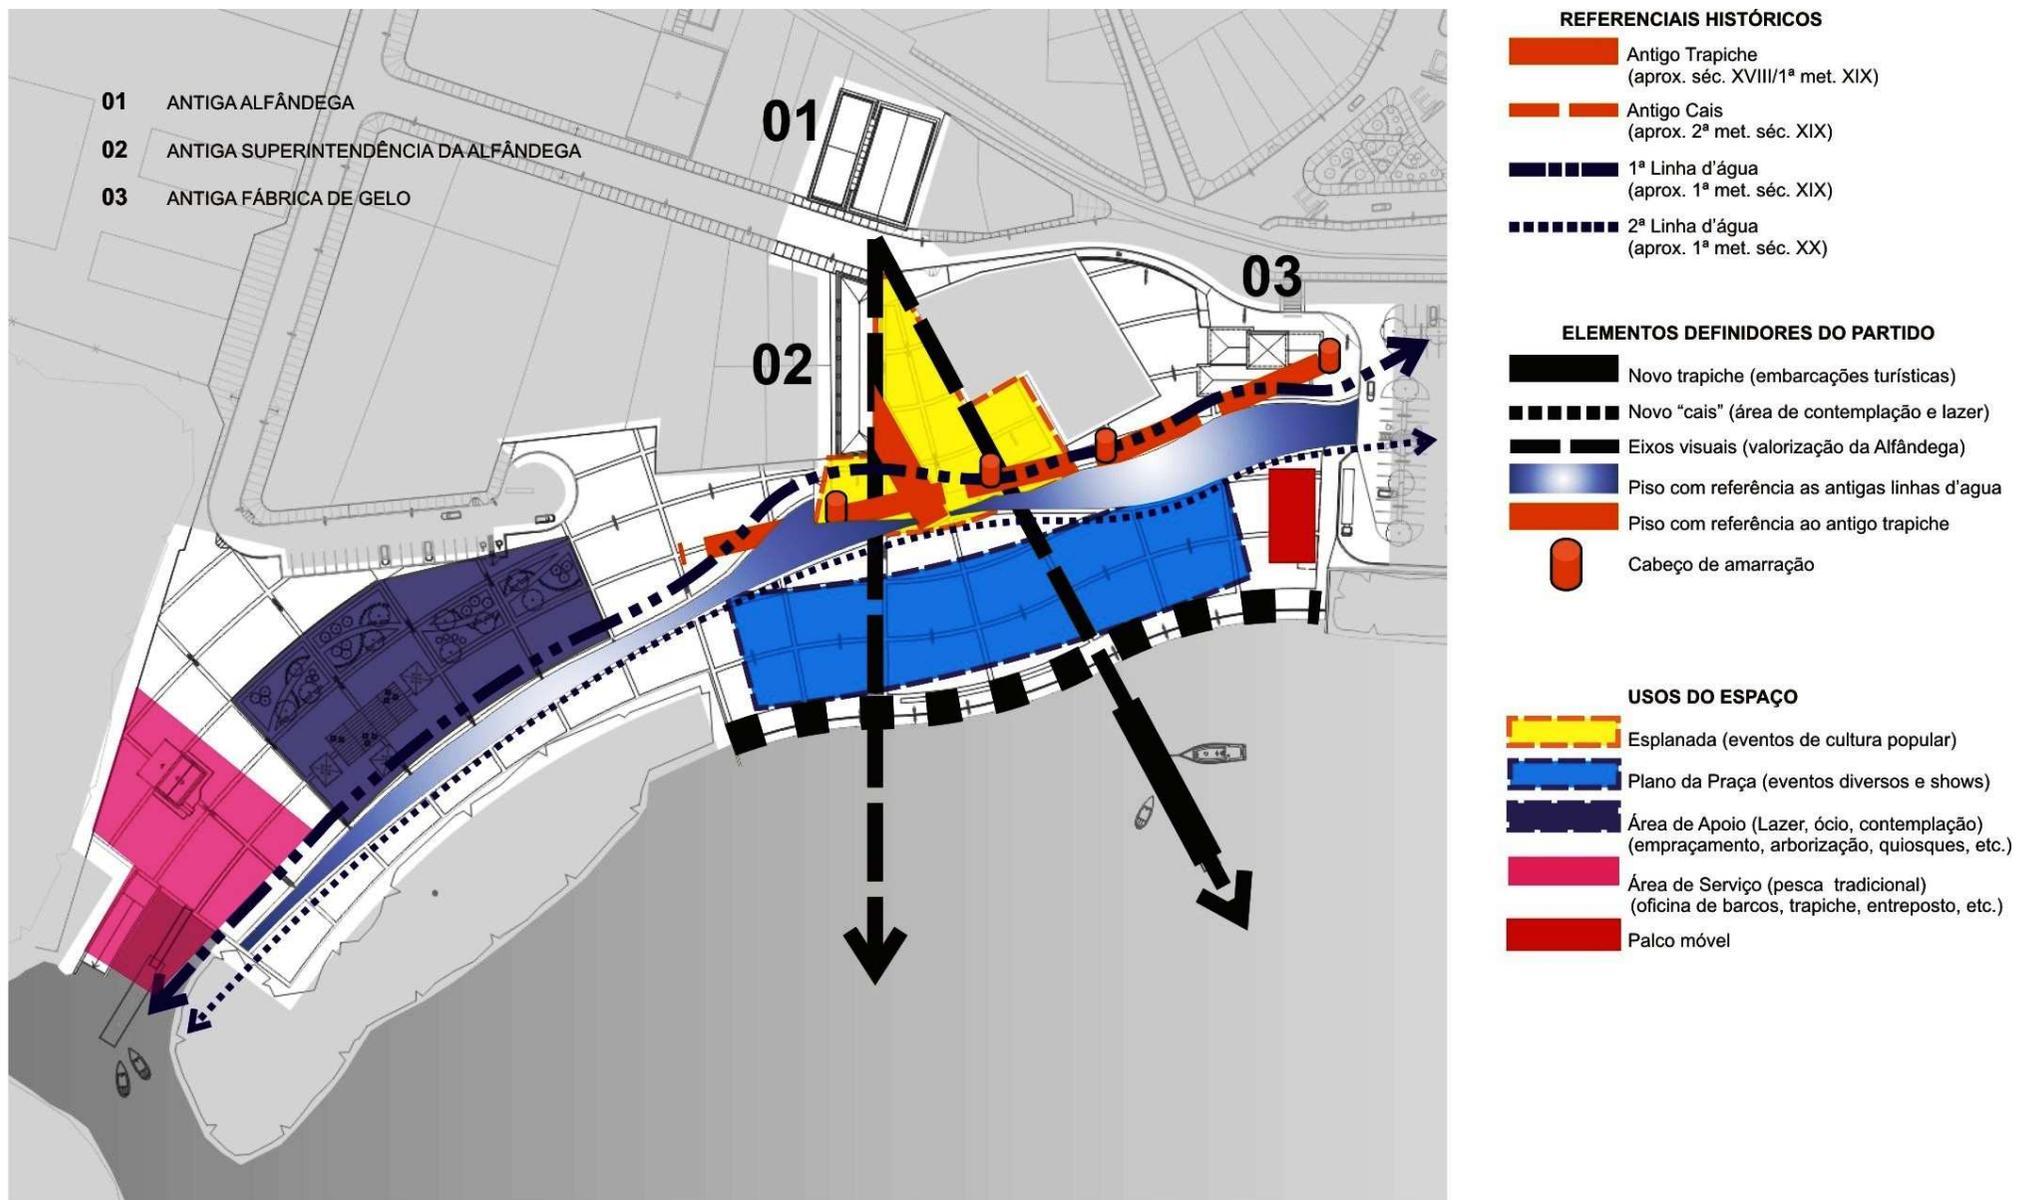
Proposta da Praça Porto do Capim – Identificação dos elementos do partido urbanístico – Fonte: CPDCHJP
